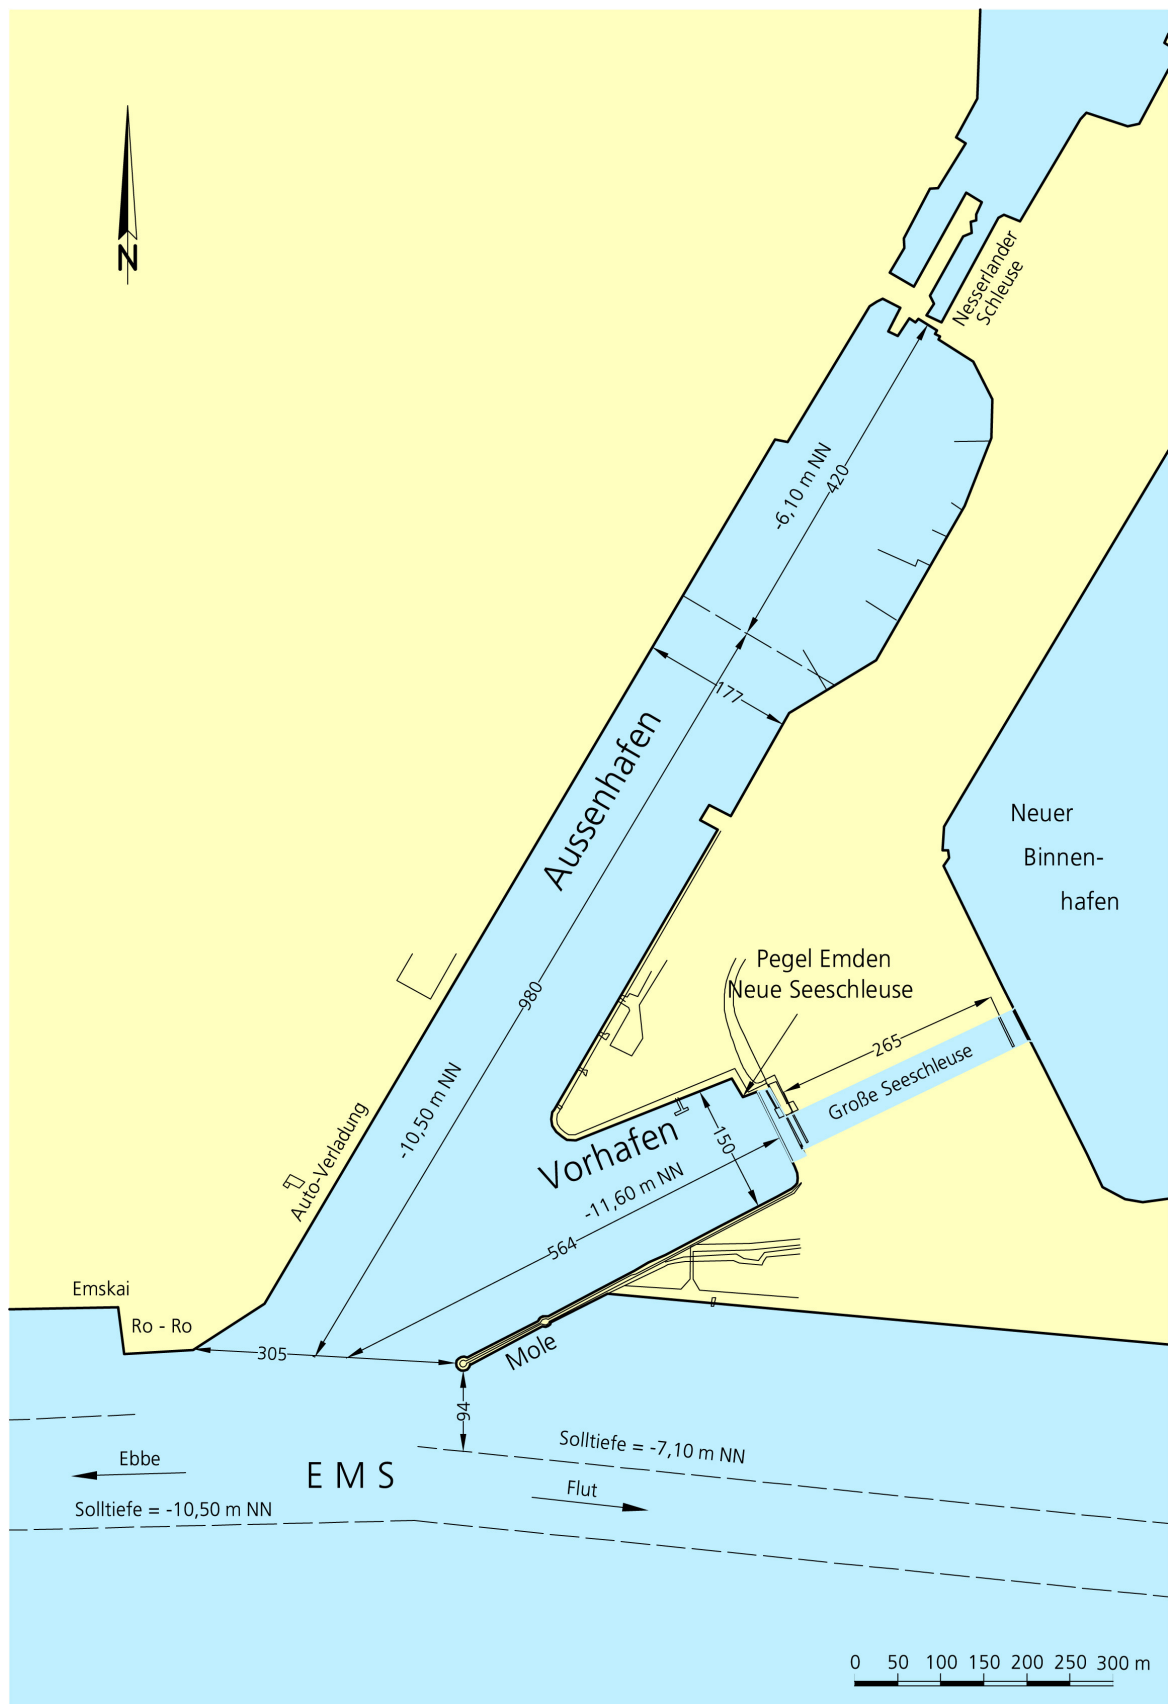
Lageplan des Emdener Vor- und Außenhafens
